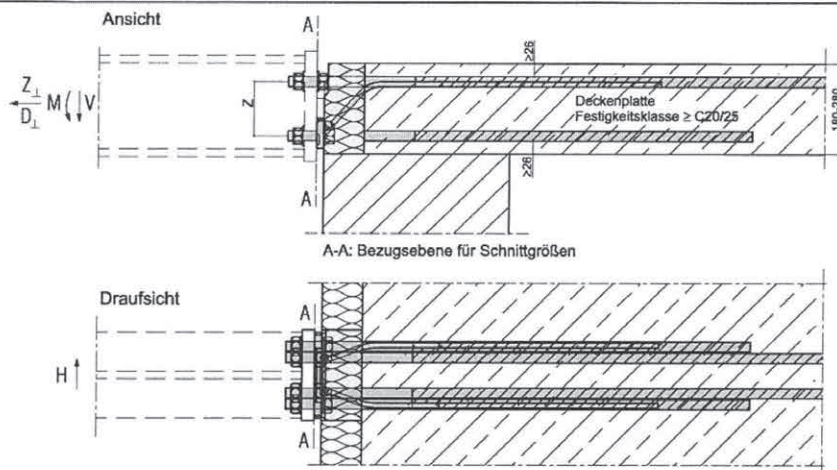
und 58: Schöck Isokorb® Typ KS20 V10, Schnittgrößendefinition
